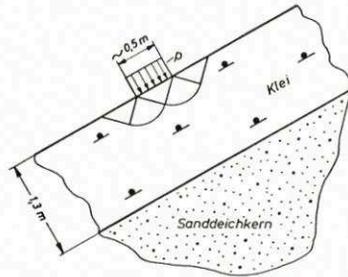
Grundbruchuntersuchung für eine Böschungsabdeckung aus Klei unter Wellendruckschlag nach DIN 4017, Blatt 1, Vornorm
